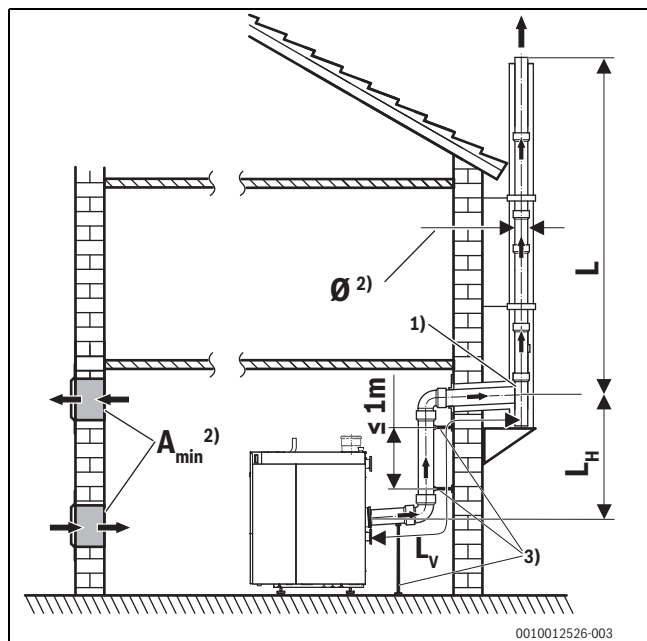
Odprowadzenie spalin bez szachtu, centrala dachowa, wariant 3
